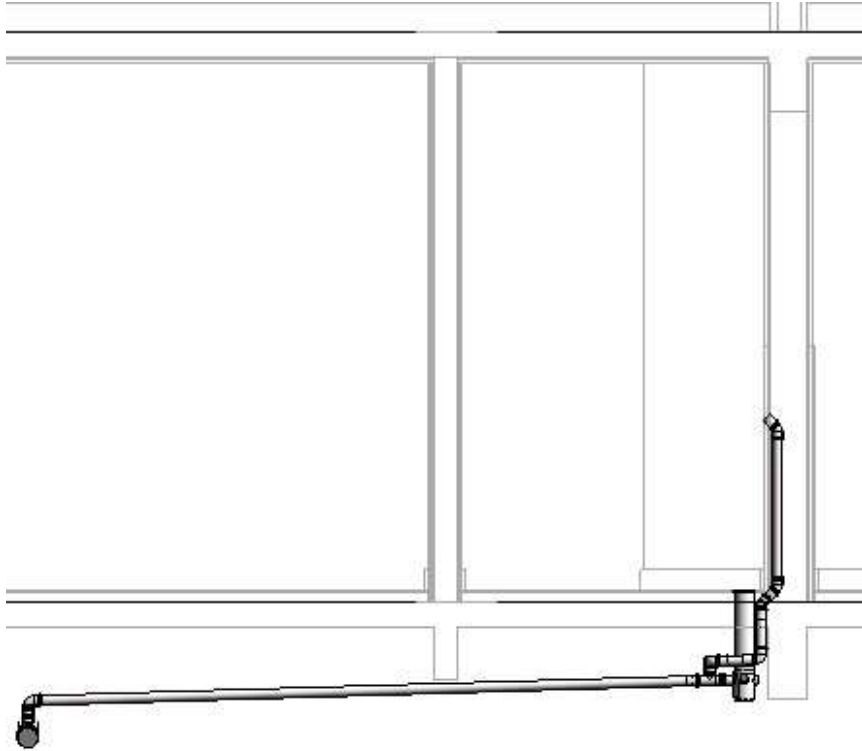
Vista 3D do banheiro no modelo elaborado.
